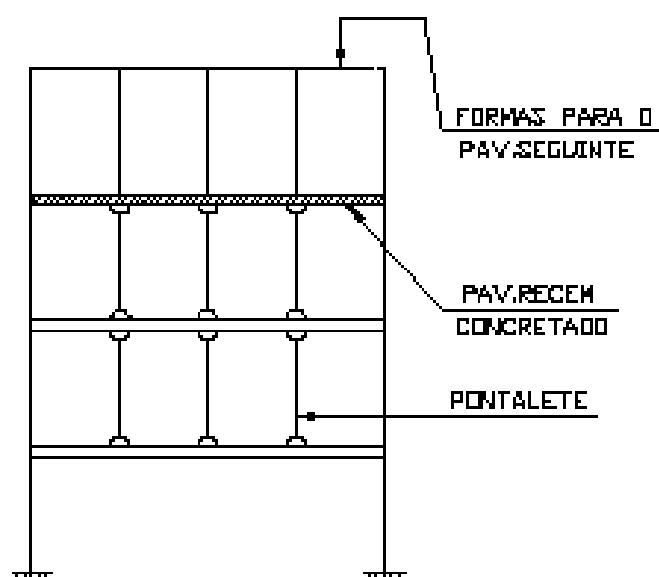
esquema de superposição de ação de construção atuantes em estruturas recém concretadas (PRADO e CORRÊA, 2002).
